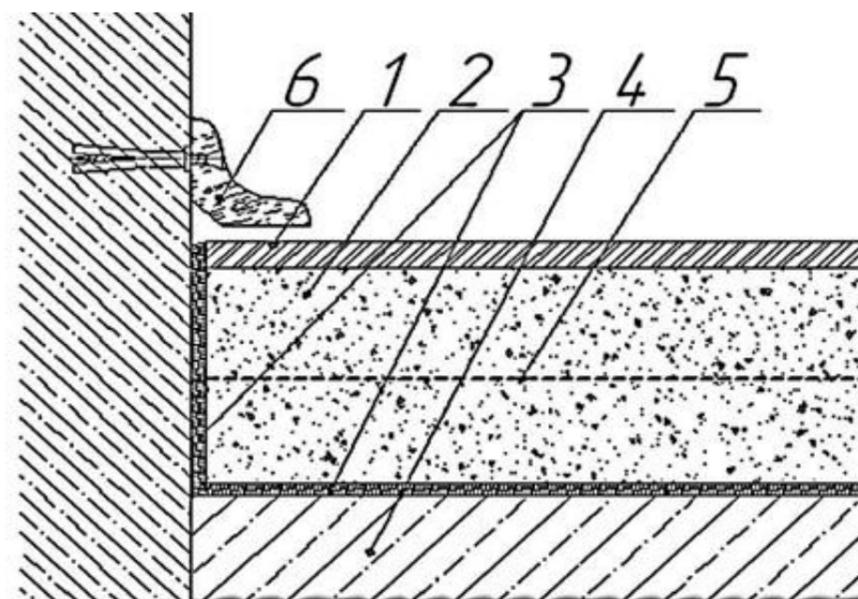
Узел межэтажного перекрытия с использованием материала «Акуфлекс»:
